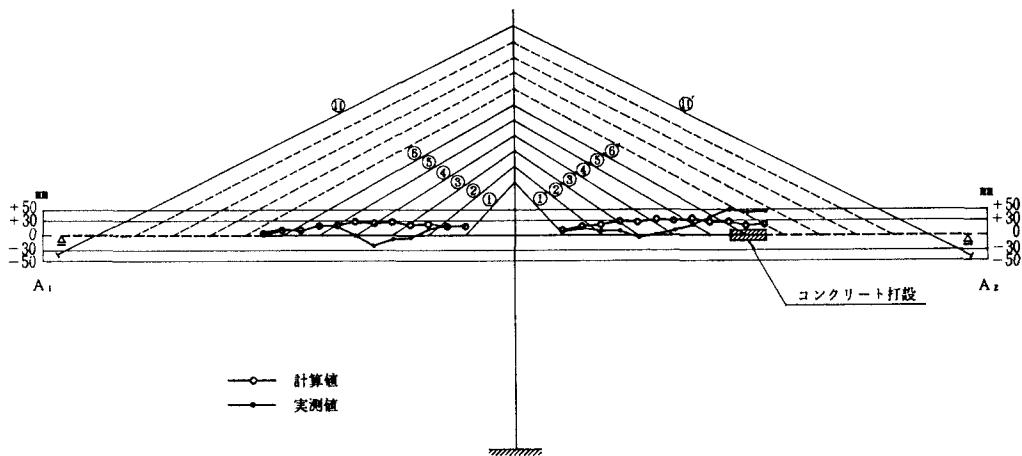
A₂側 第5ブロック コンクリート打設 (STEP E 8)
